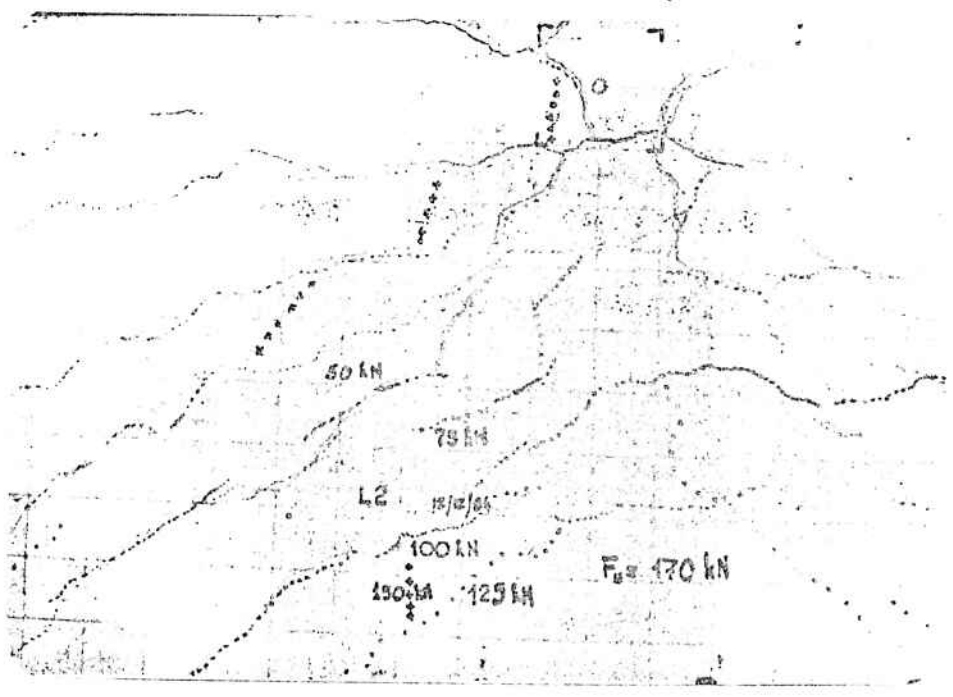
FISSURAÇÃO FINAL DA LAJE L 2
